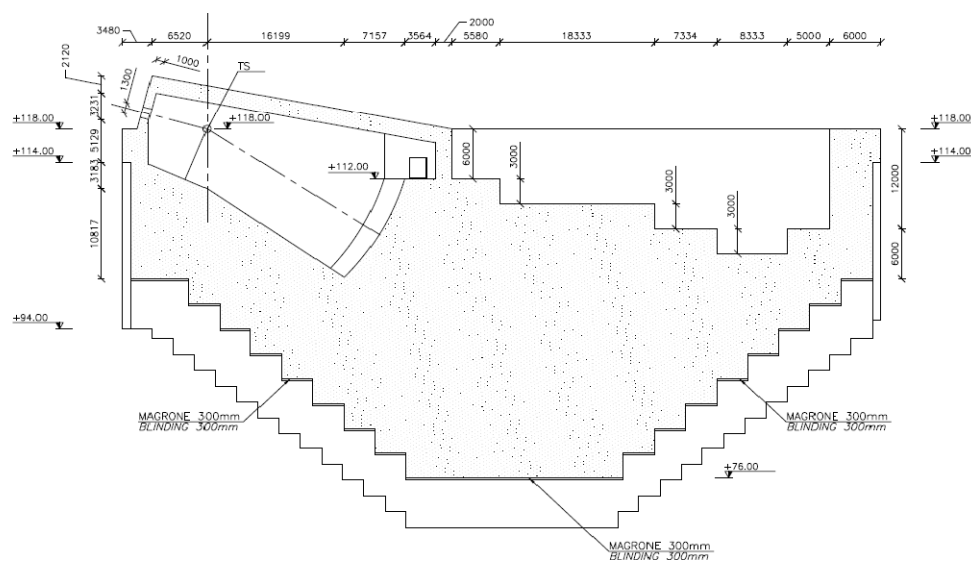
Layout del blocco d'ancoraggio calabrese
